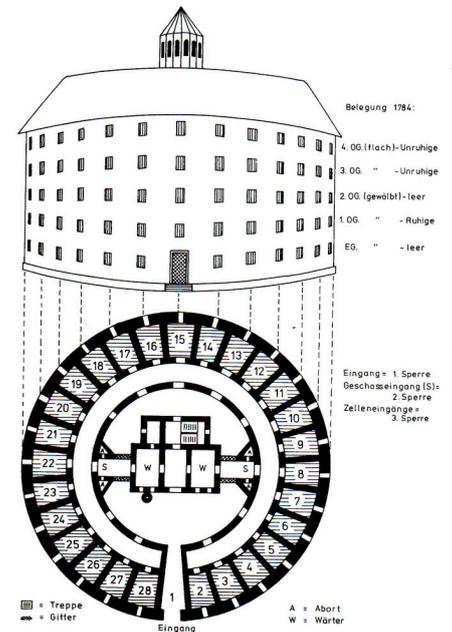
Ansicht/Grundriss Narrenturm
